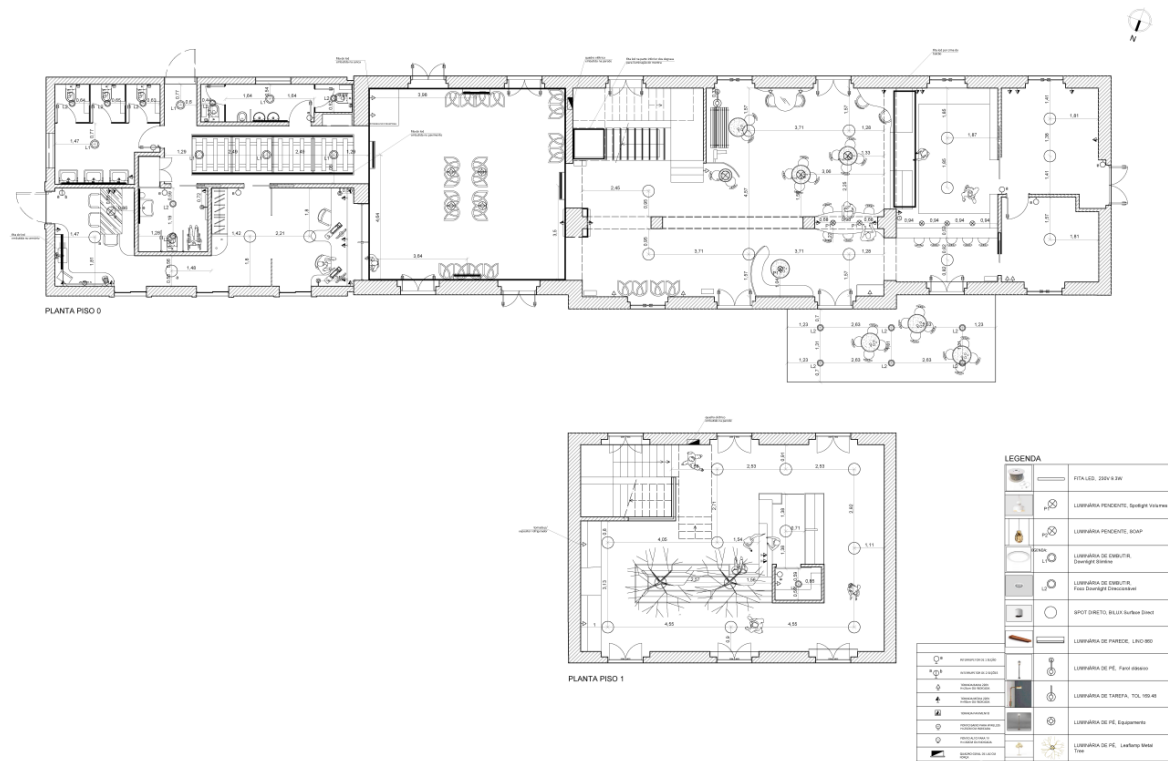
Planta de Iluminação e tomadas cotada, Piso 0 e Piso 1
